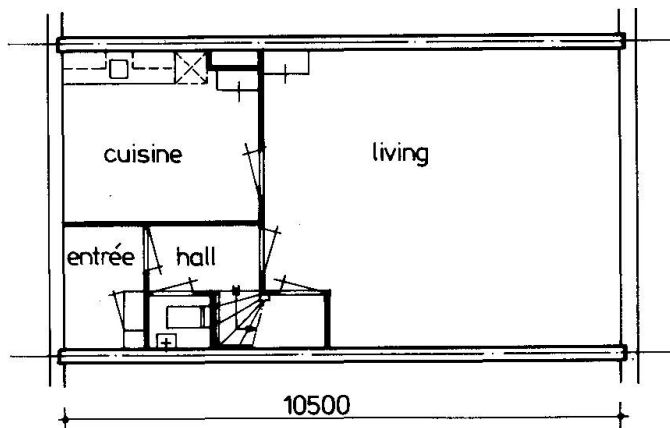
REZ-DE-CHAUSSÉE (VARIANT)
